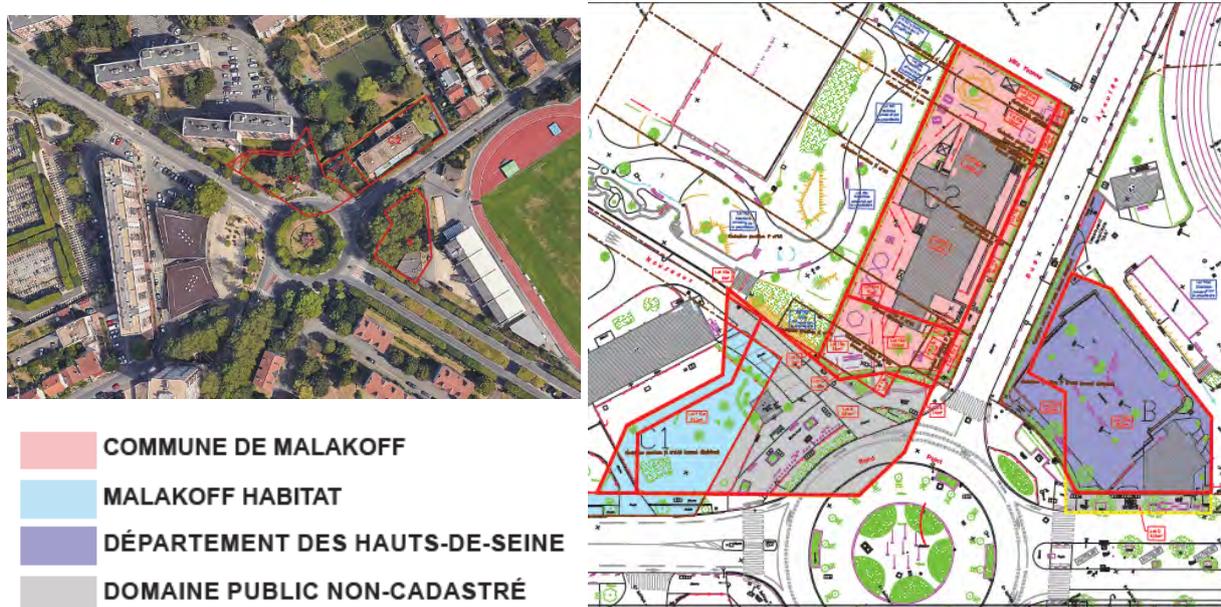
Plan aérien et Plan de maîtrise foncière existants
